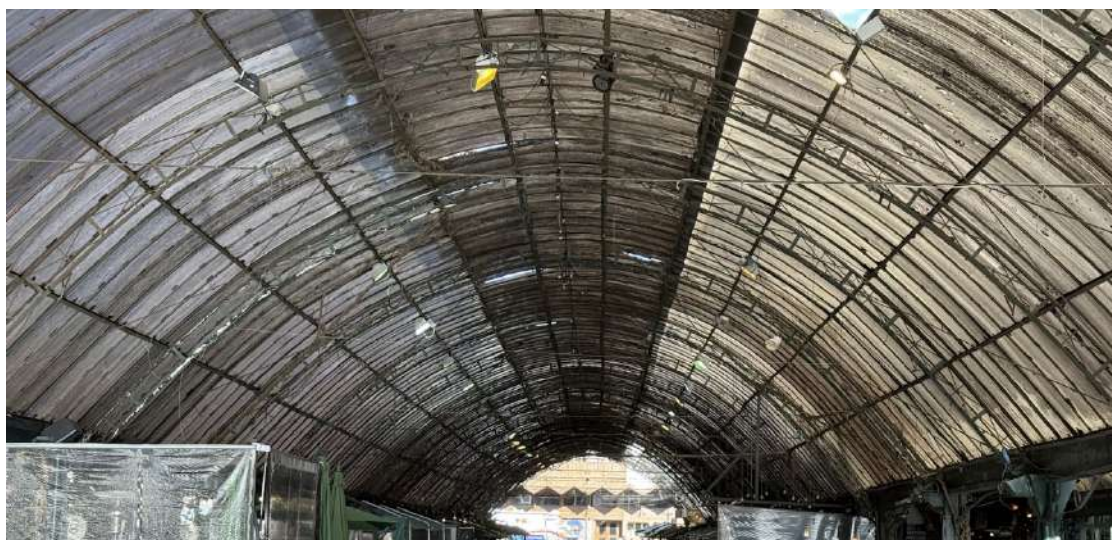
Arcos e cobertura aparente, vista em direção à Avenida Borges de Medeiros
